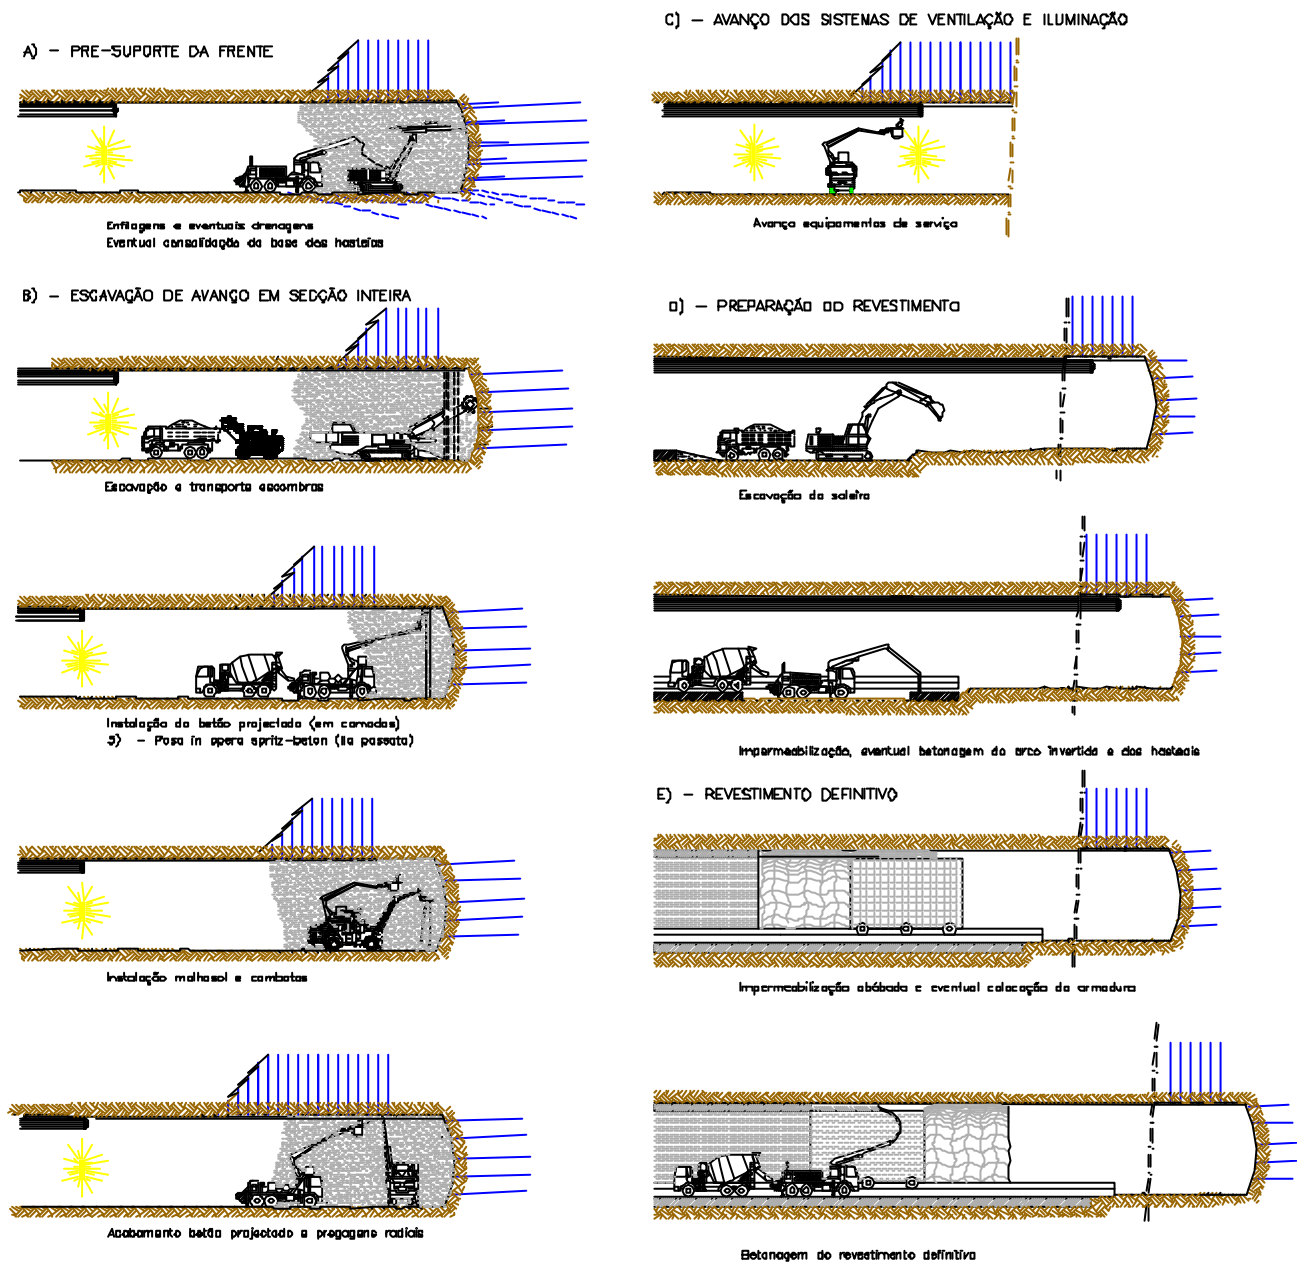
Exemplo de esquema de faseamento construtivo de um túnel mineiro
